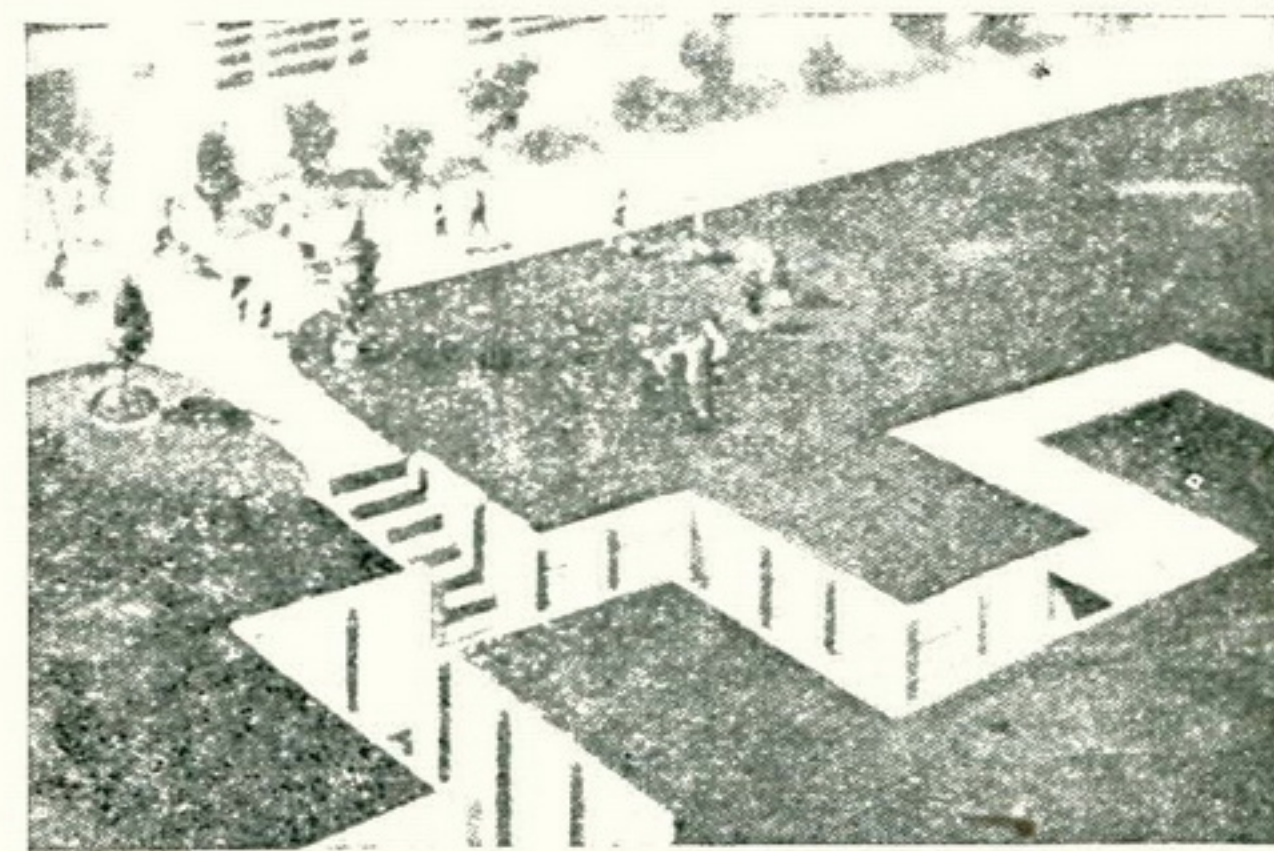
Підземна траншея, вислана бетонними плитами по залізобетонних рамах.
